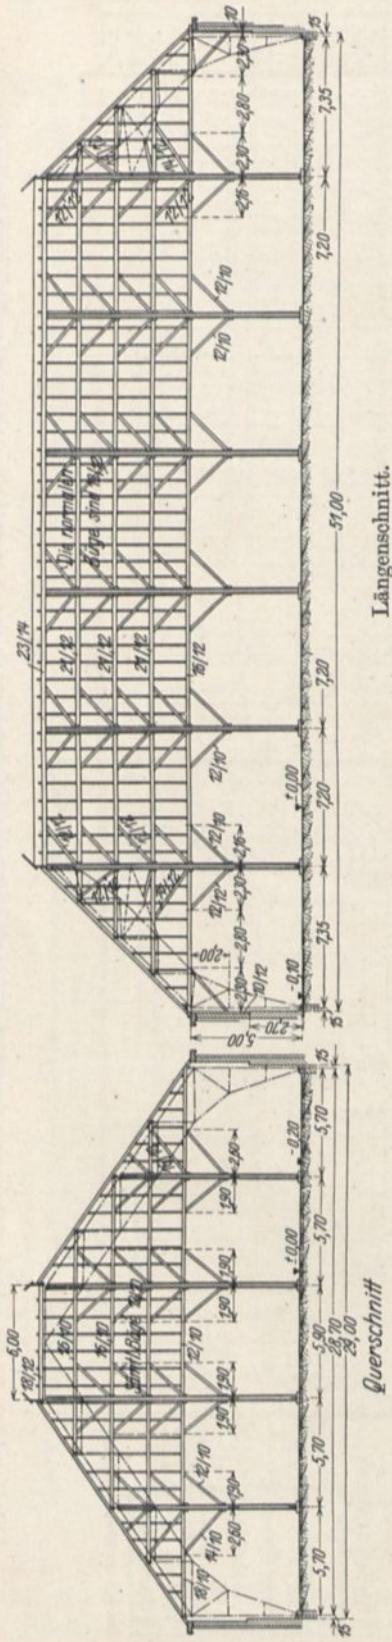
Frankenhalle Würzburg. Anordnung der Holzkonstruktion der großen Halle in Grundriß und Schnitt.
